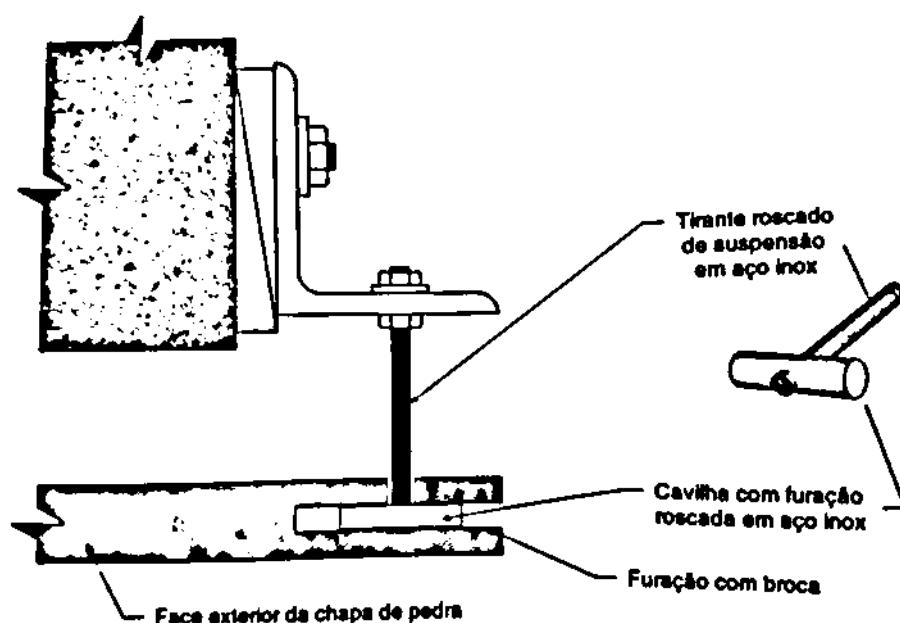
Esquema de fixação com cavilha, para superfícies horizontais [25].
